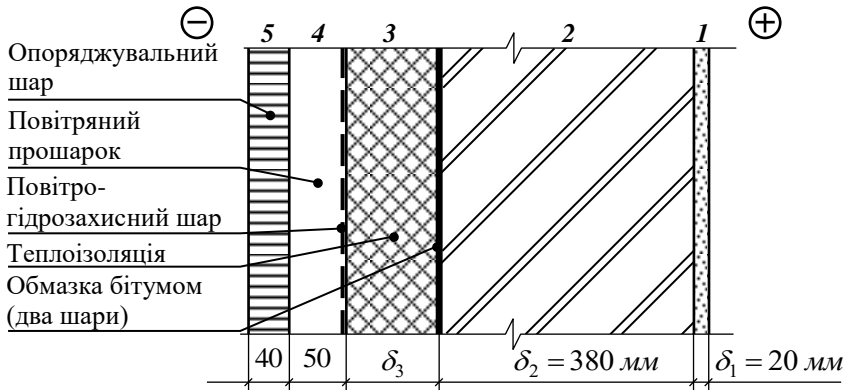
Розрахункова схема стіни вентиляованого фасаду
